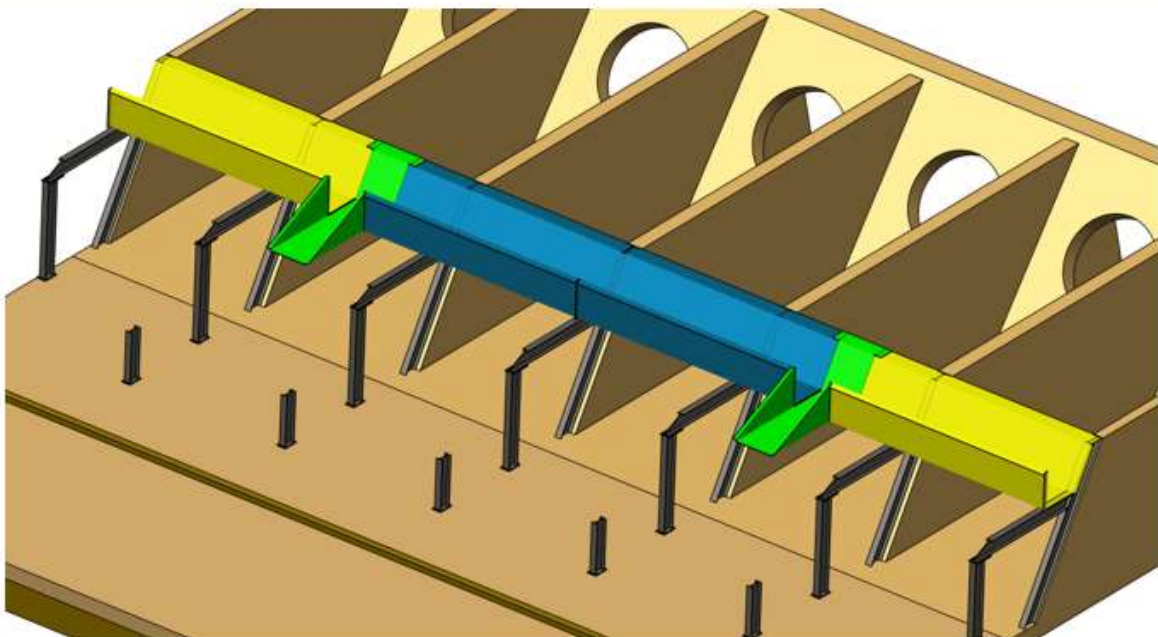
Vue d'ensemble exutoire et goutte de récupération
